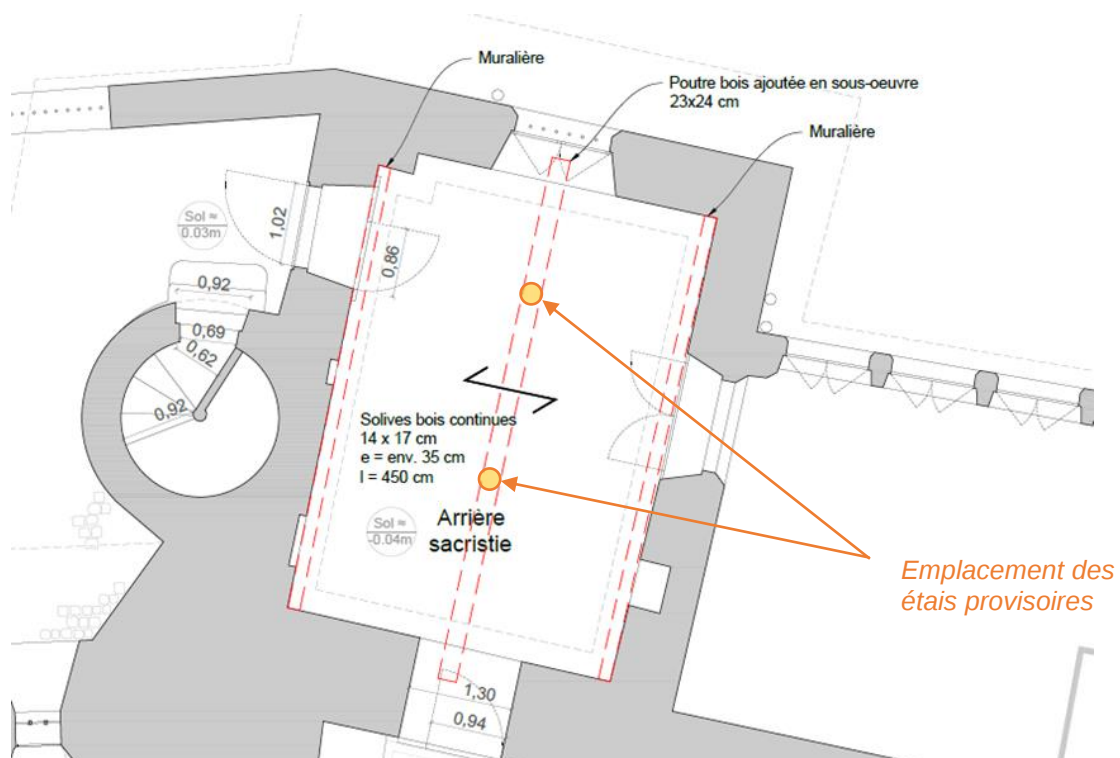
Schéma de disposition des étais sous la poutre centrale
